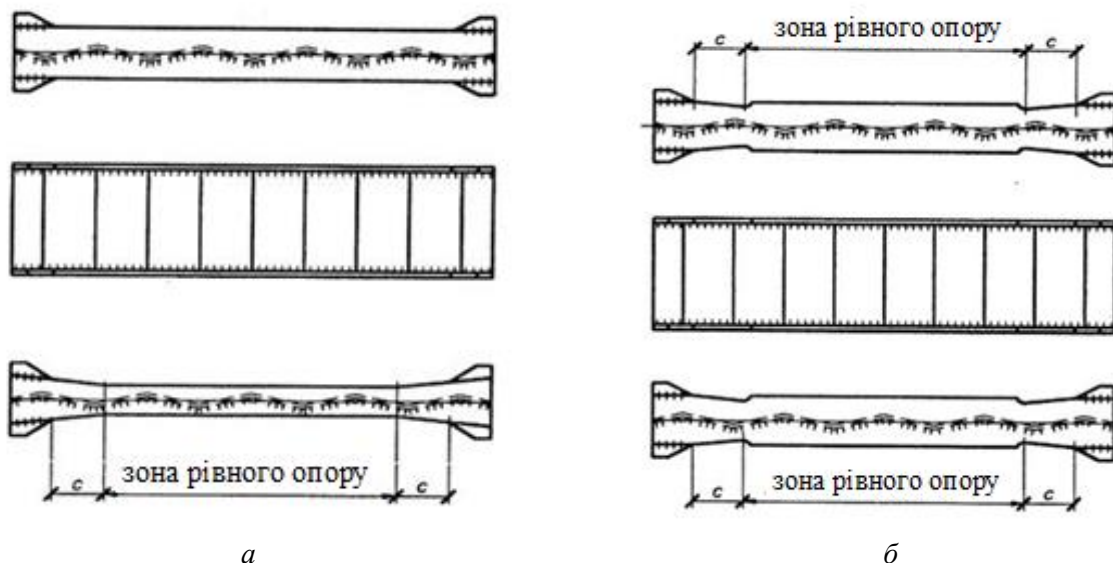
Сталеві ригелі з поперечно-гофрованими стінками сейсмостійких каркасних будівель:
